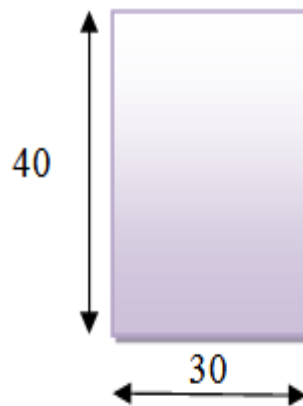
Pré dimensionnement des poutres secondaire.
